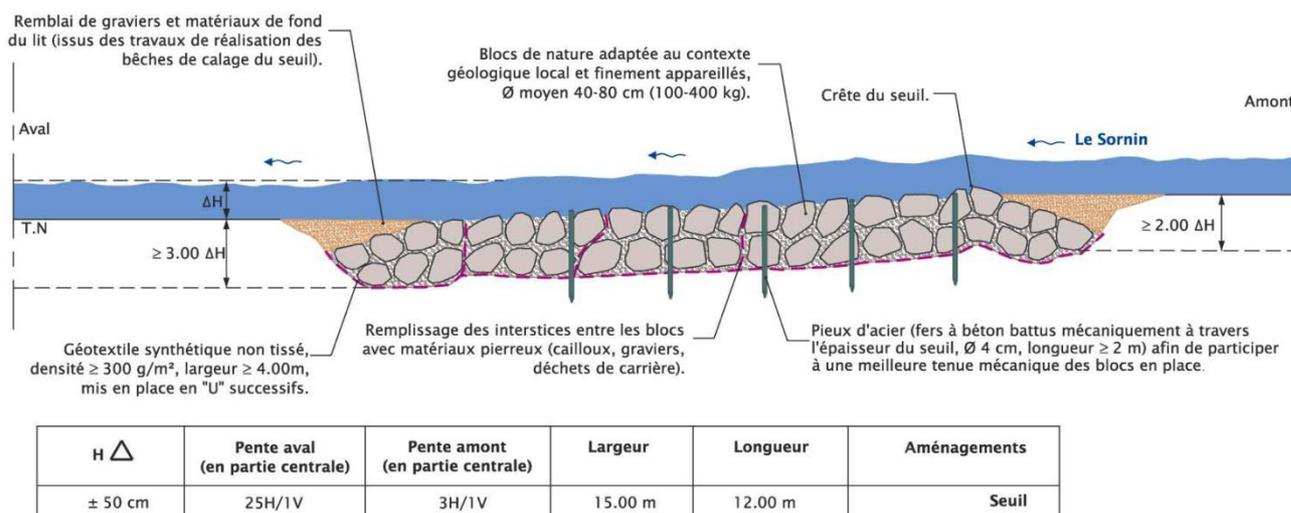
Seuil de fond au niveau de l'ouvrage.
